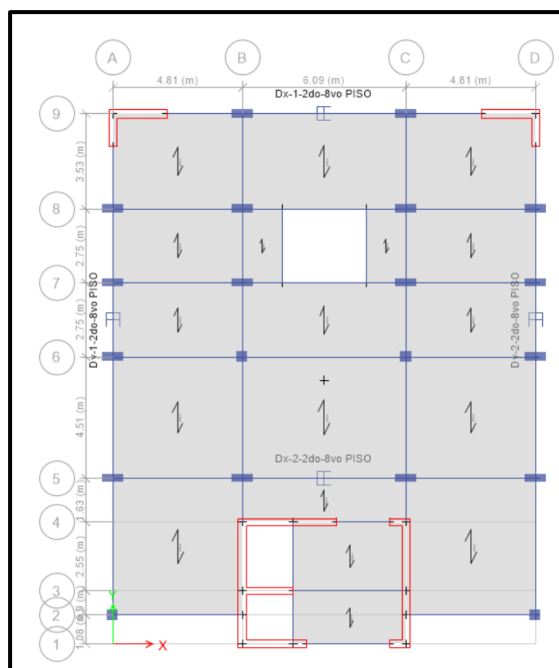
Modelamiento edificación multifamiliar con Taylor, vista en planta 1er piso.
